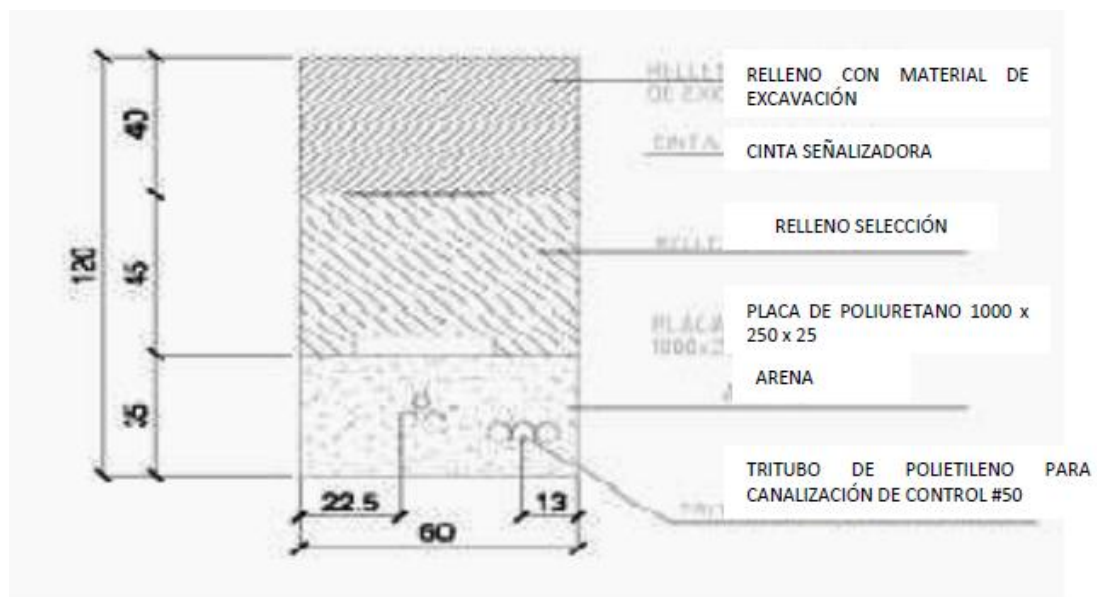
Disposición de cables de potencia en la Sección Zanja Tipo I.
